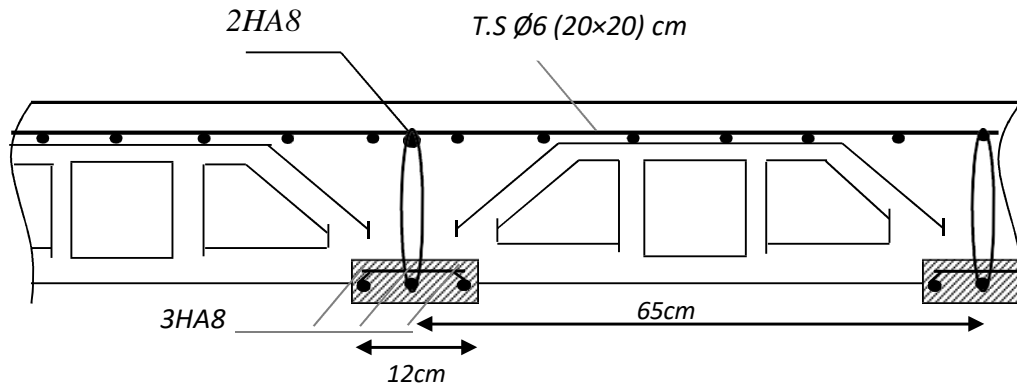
Détails du ferrailage du plancher en corps creux.
